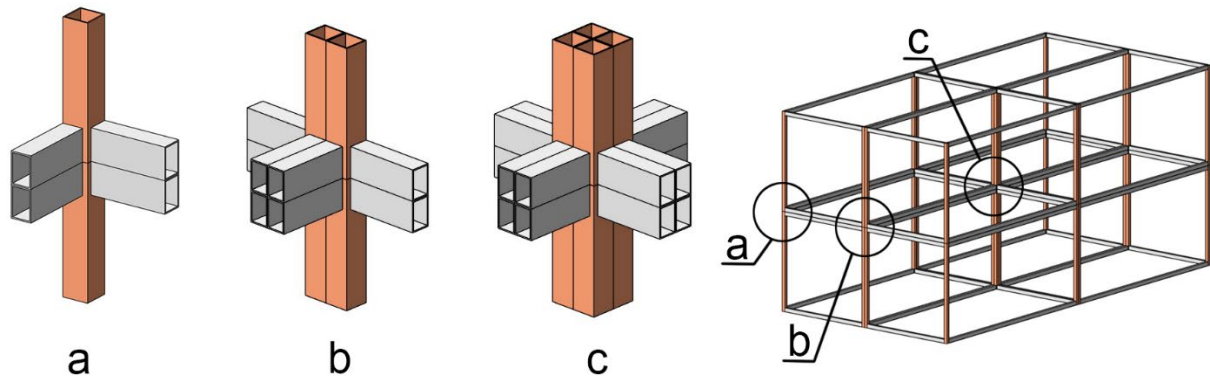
Типы межмодульных соединений по месту расположения в модульной конструкции: (a) угловое соединение, (b) боковое соединение, (c) внутреннее соединение
